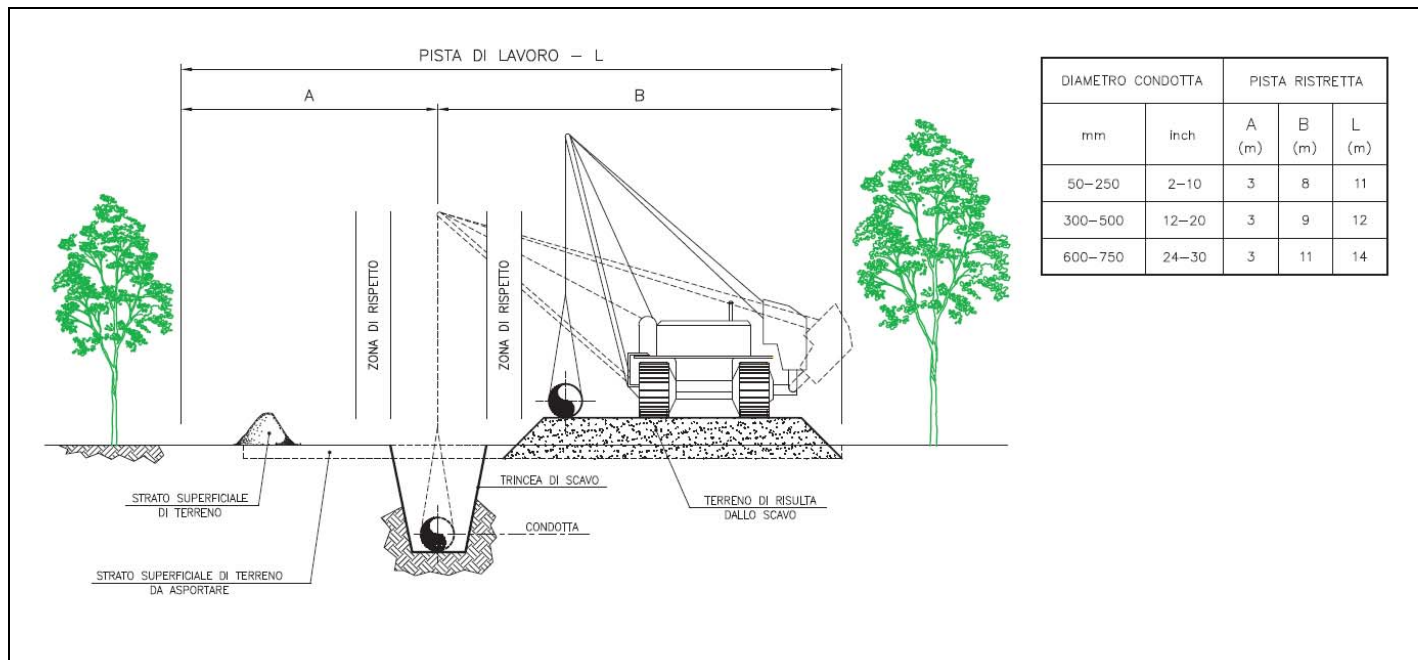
Sezione tipica della pista di lavoro “ristretta” (STD 00401B)
